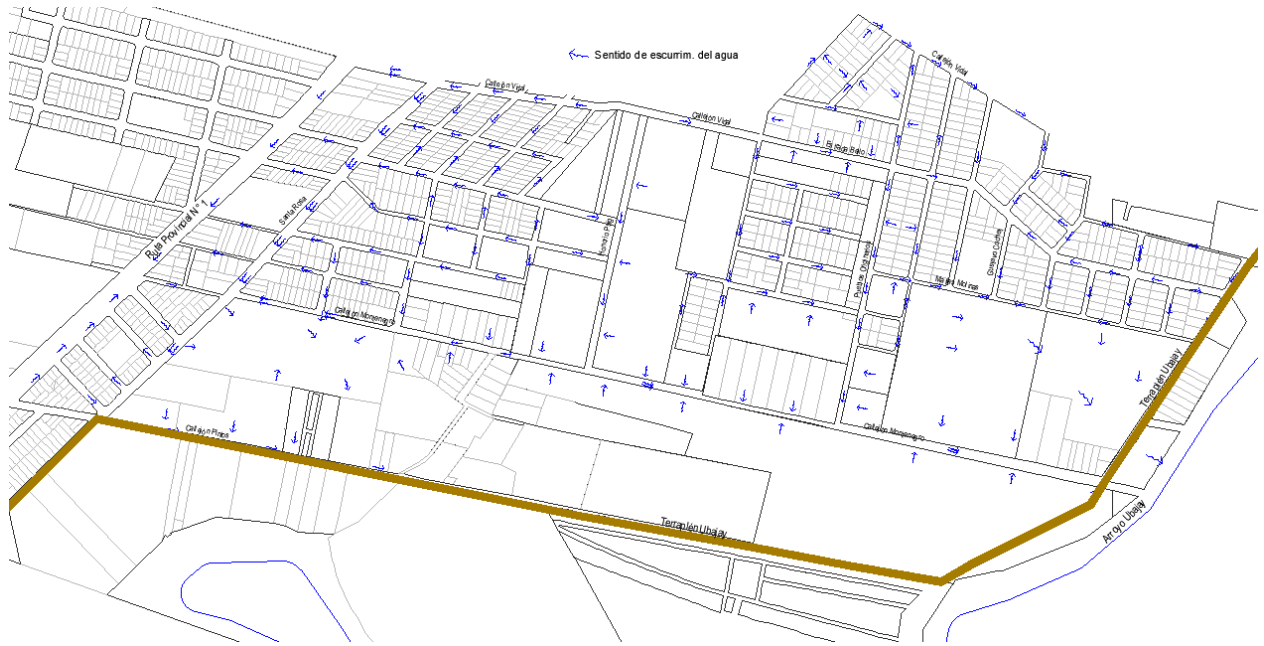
Dinámica Hídrica - Ver Planimetría: Plano n°5. Fuente: Elaboración propia
